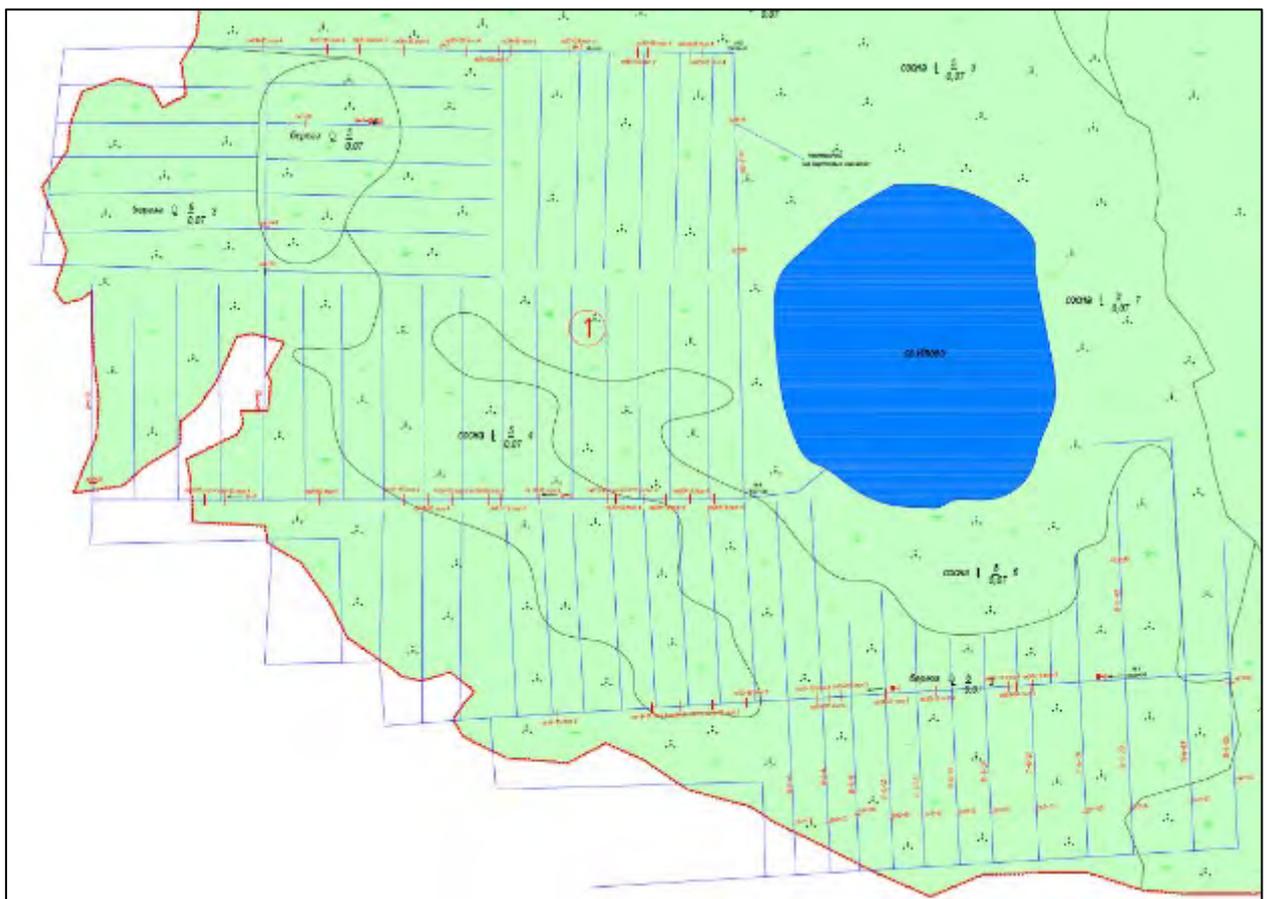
Схема запланированных работ на участке № 1
